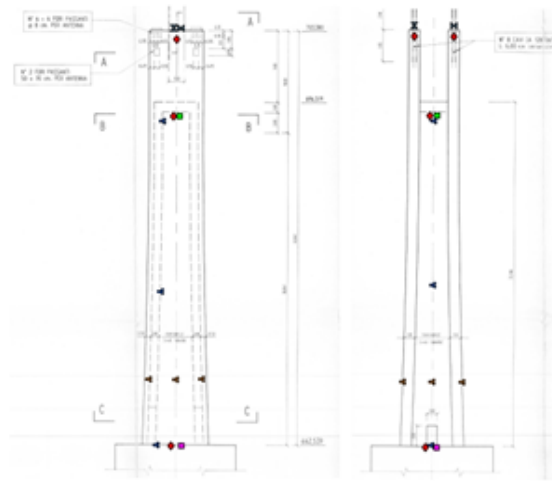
Prospetto trasversale e longitudinale di una pila generica
